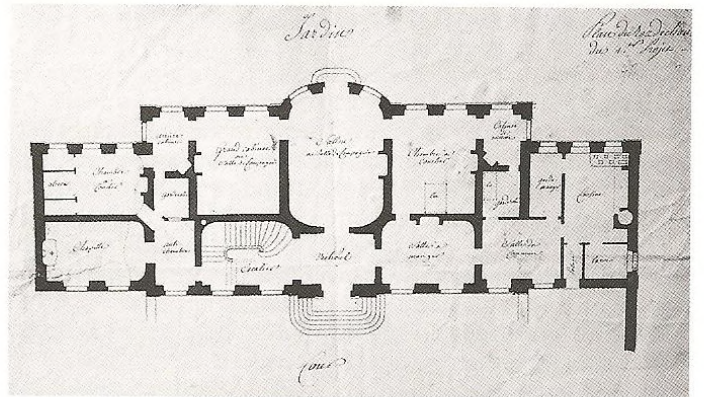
Mansart de Sagonne, *Plan au rez-de-chaussée du premier projet pour le château*, 1753 ? (archives du château).
